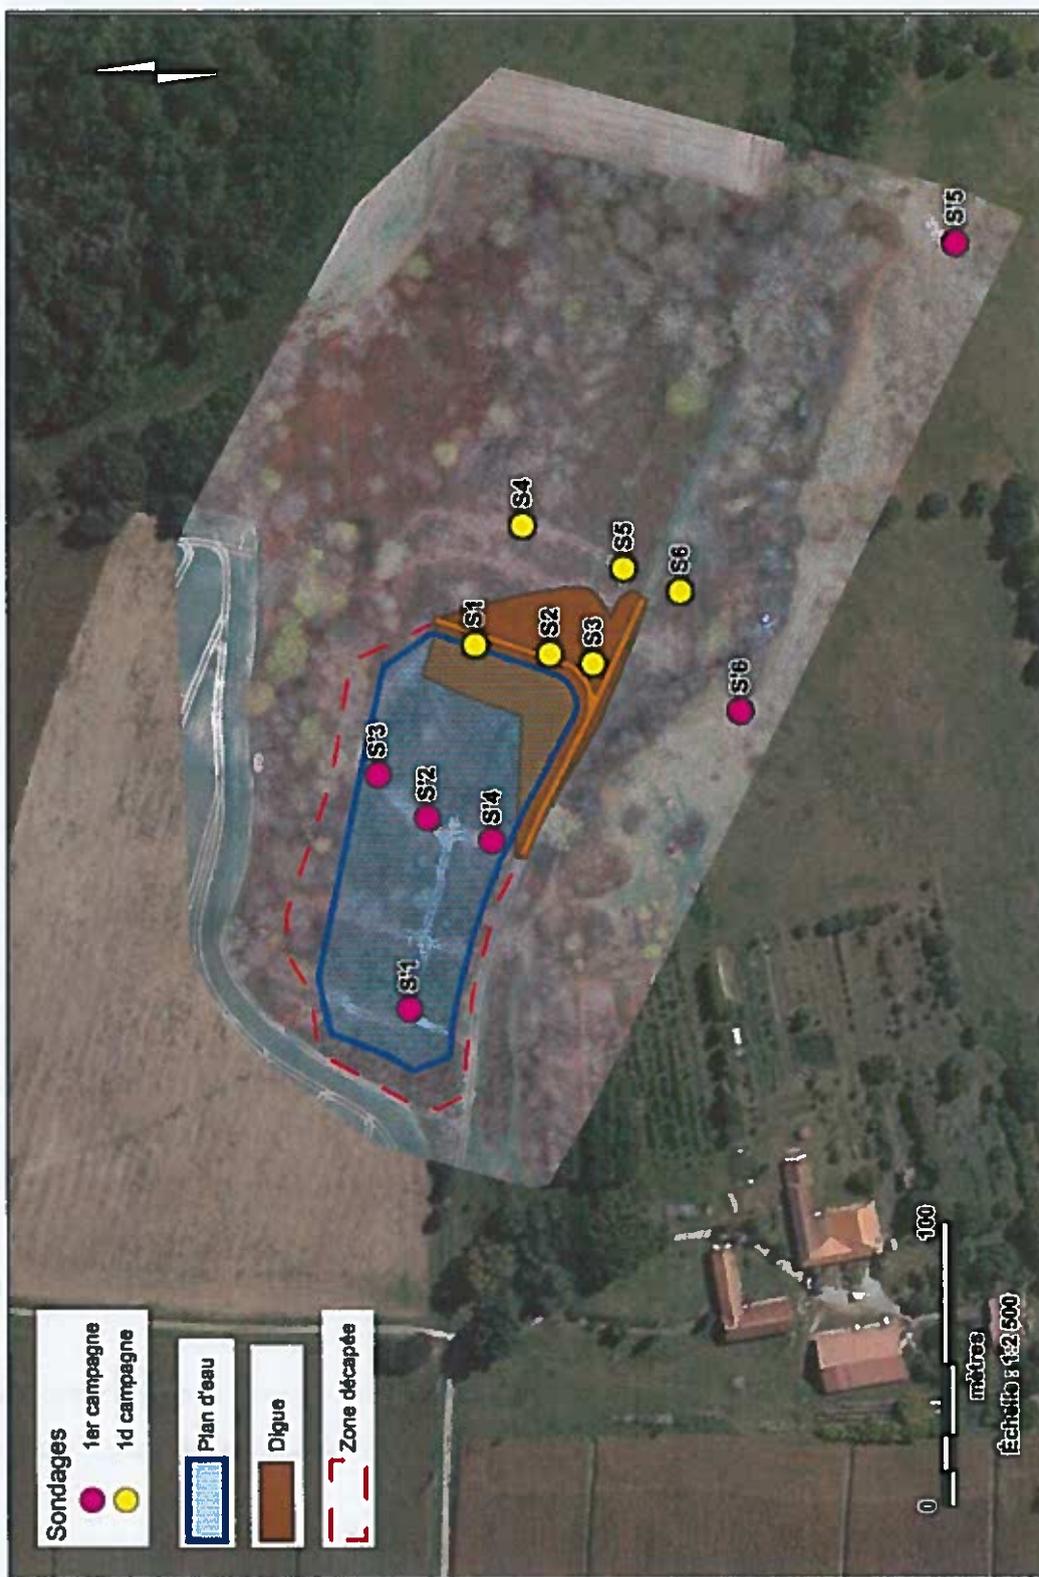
Localisations des sondages (fond de plan drone CETRA)
